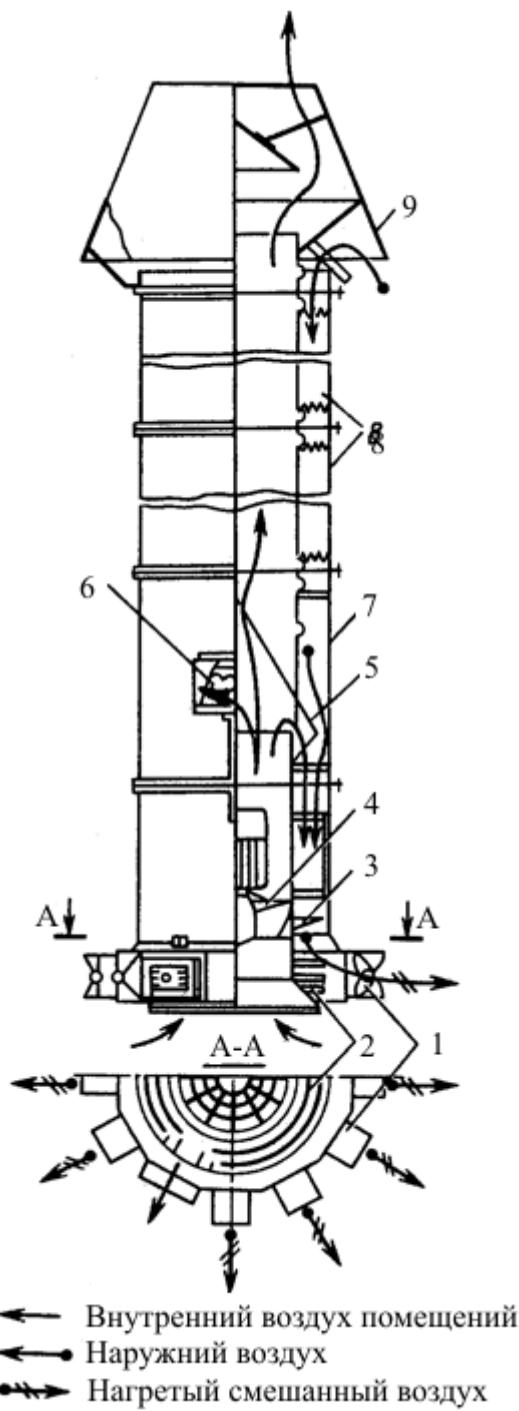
Приточно-вытяжная установка типа ПВУ:
